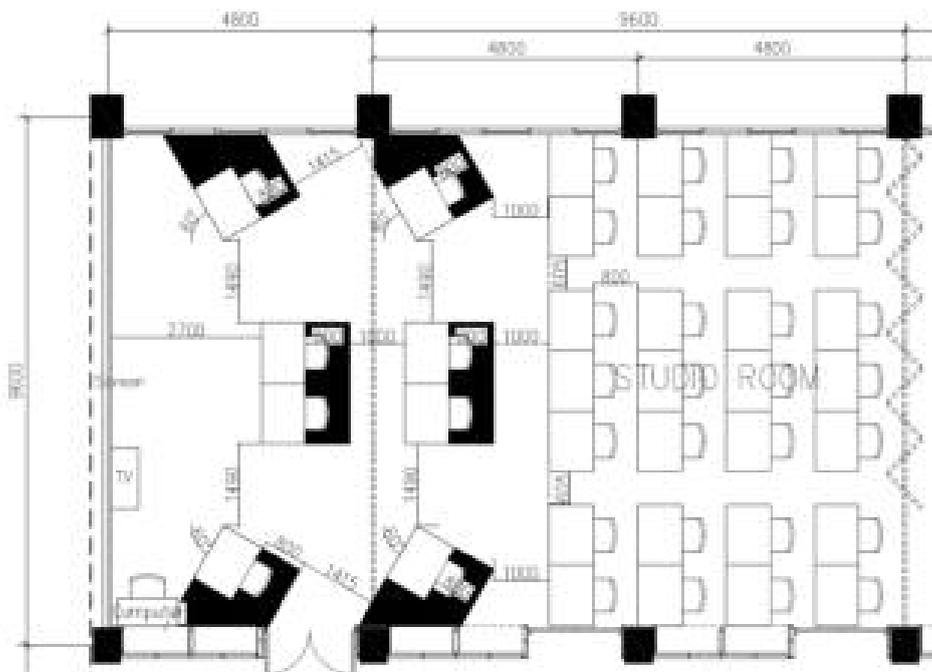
Simulasi Alternatif Denah Ruang Kelas Luring
